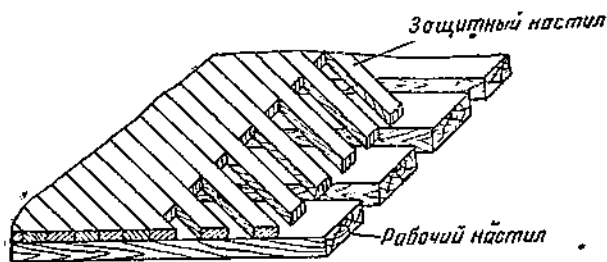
Двухслойное деревянное основание под рулонную кровлю.
